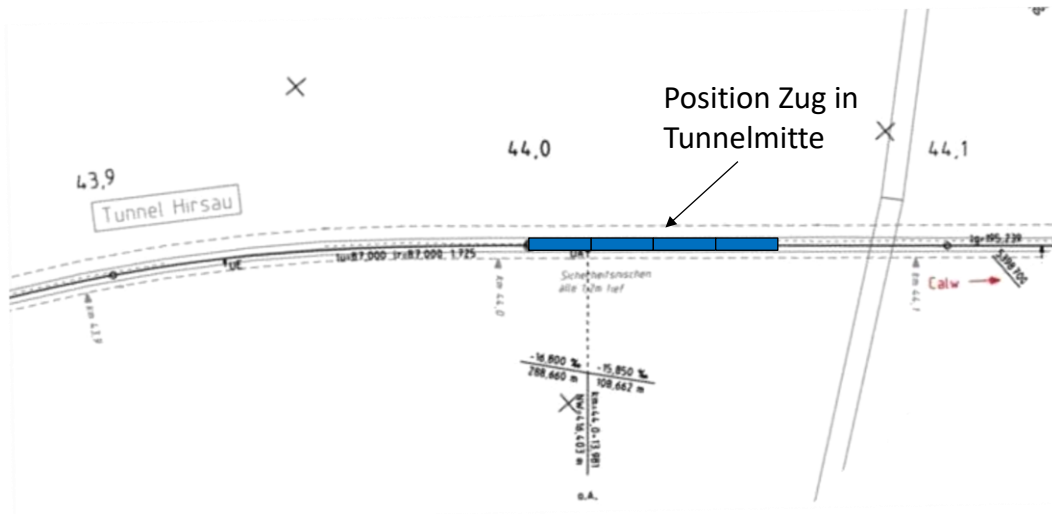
Positionierung des Zugs in Mitte des Tunnels Hirsau (Ausschnitt aus Lageplan 16)
